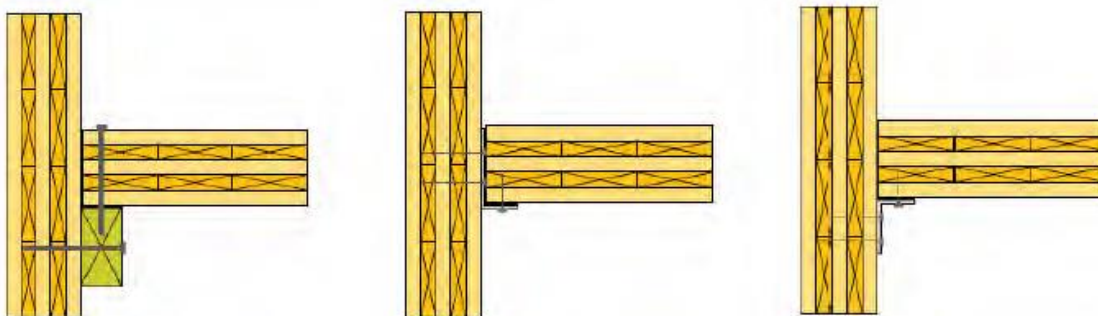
Ligações do tipo parede – pavimento usadas no sistema construtivo *balloon frame* (Mandegarlan e Milev, 2010).
